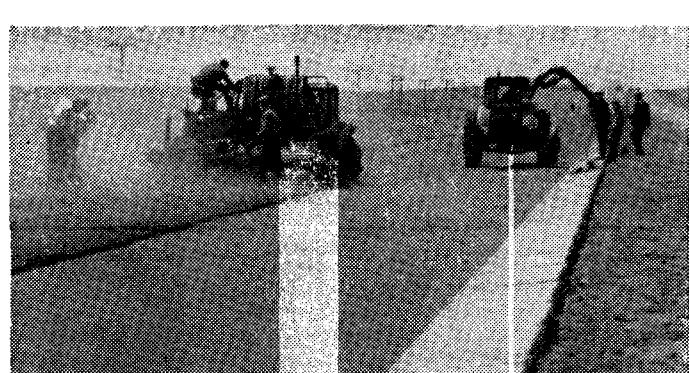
Укладка асфальтового бетона и краевых упорных плит на дороге Алма-Ата — Новоилийск
